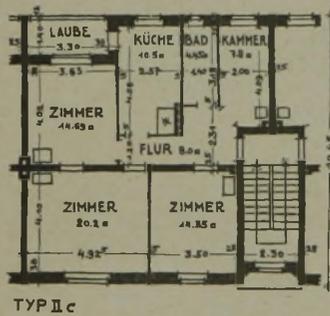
Grundriß einer Dreizimmerwohnung mit Kammer im Hufeisen.
